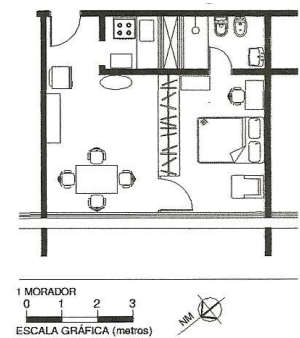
Planta baixa de apartamento do bloco B (Fonte: GALVÃO e ORNSTEIN, 2008, p.8)
